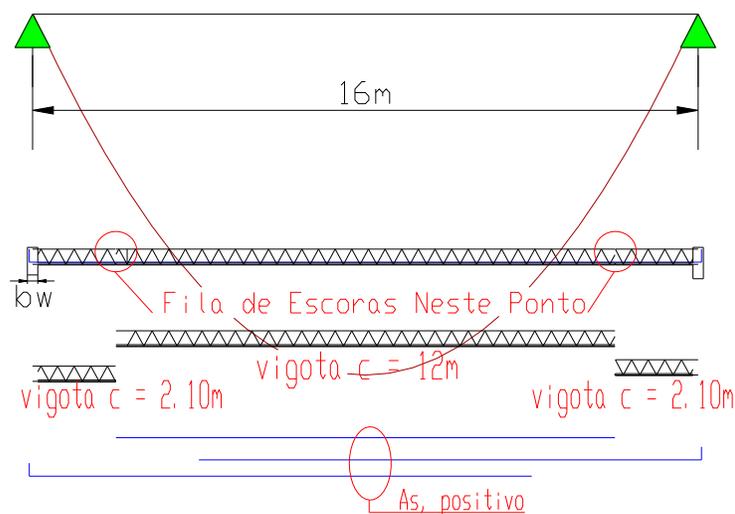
Detalhamento laje vão maior que 12m.
